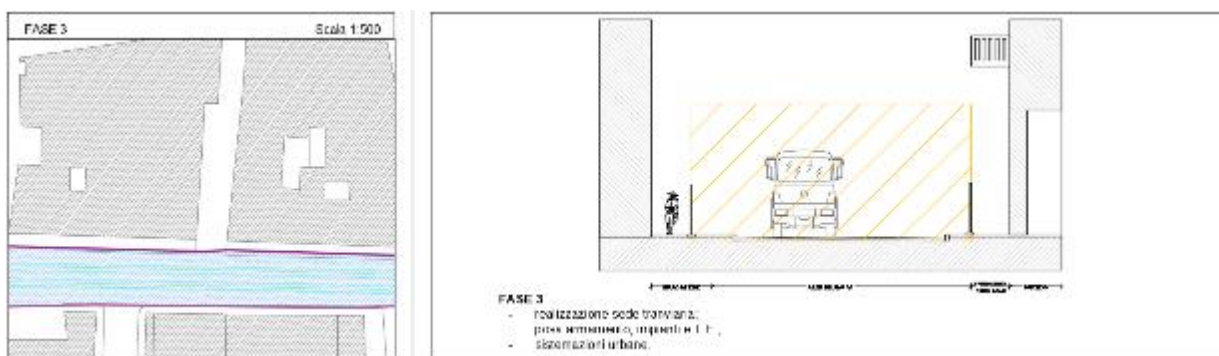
Tipologico cantiere con sede promiscua Fase 3
